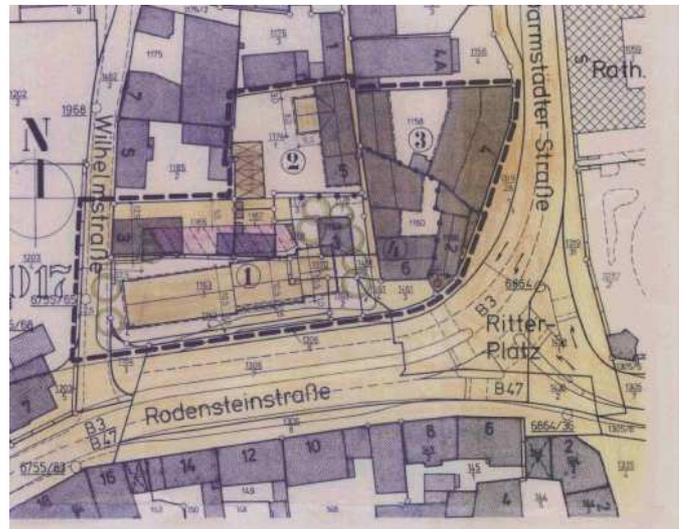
Bebauungsplan BO 19 (o.M.)
